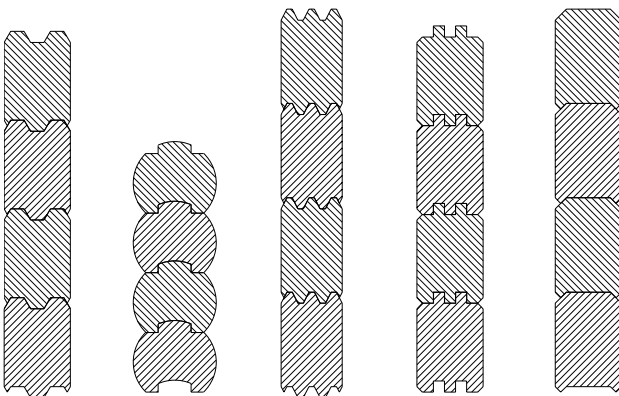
Secciones tipo del muro de carga en las estructuras macizas de madera.
